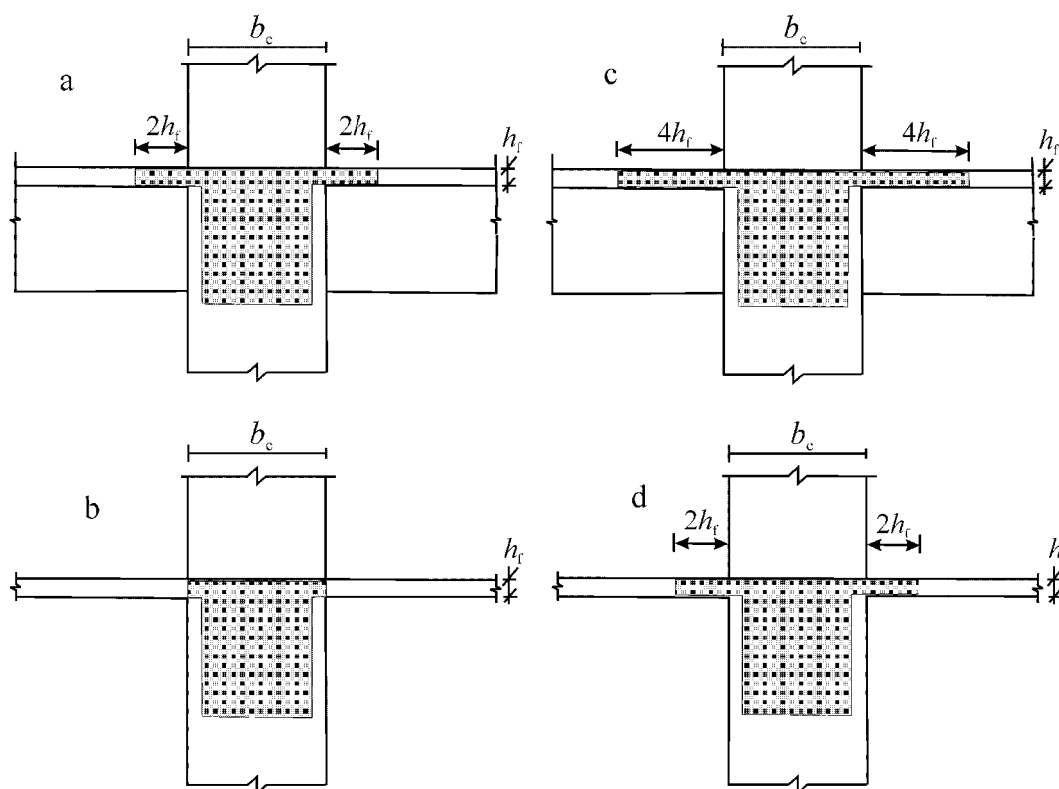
Anchura eficaz del ala b_{eff} para vigas que confluyen en pilares
